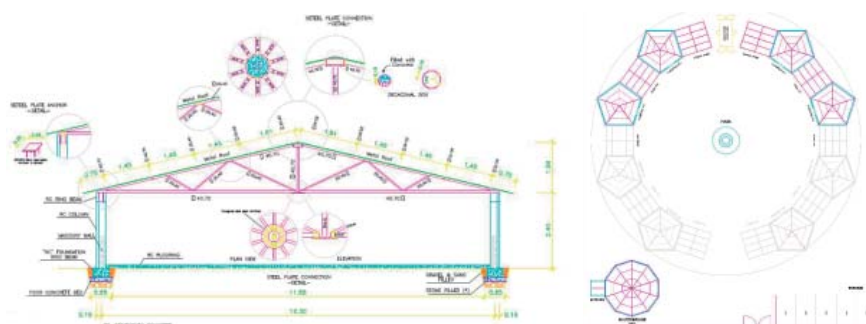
Planta del nuevo proyecto y sección. En la planta se ve la disposición de los perfiles metálicos en cubierta. En la sección se explica cada perfil, y su unión entre ellos.
